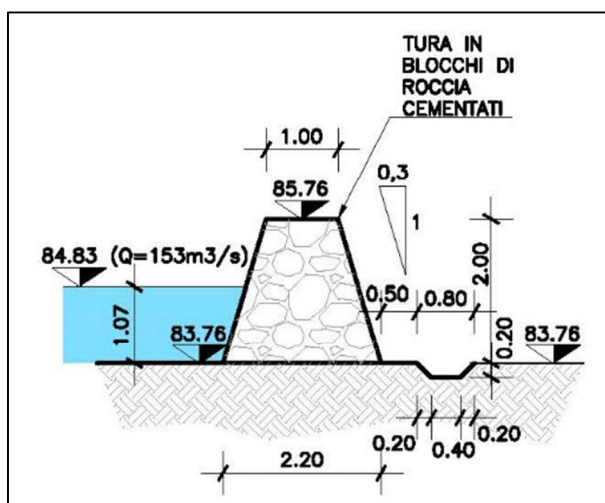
Opere di chiusura in massi cementati - Stagione 1 - 2 - Sezione tipo a valle del Manufatto
